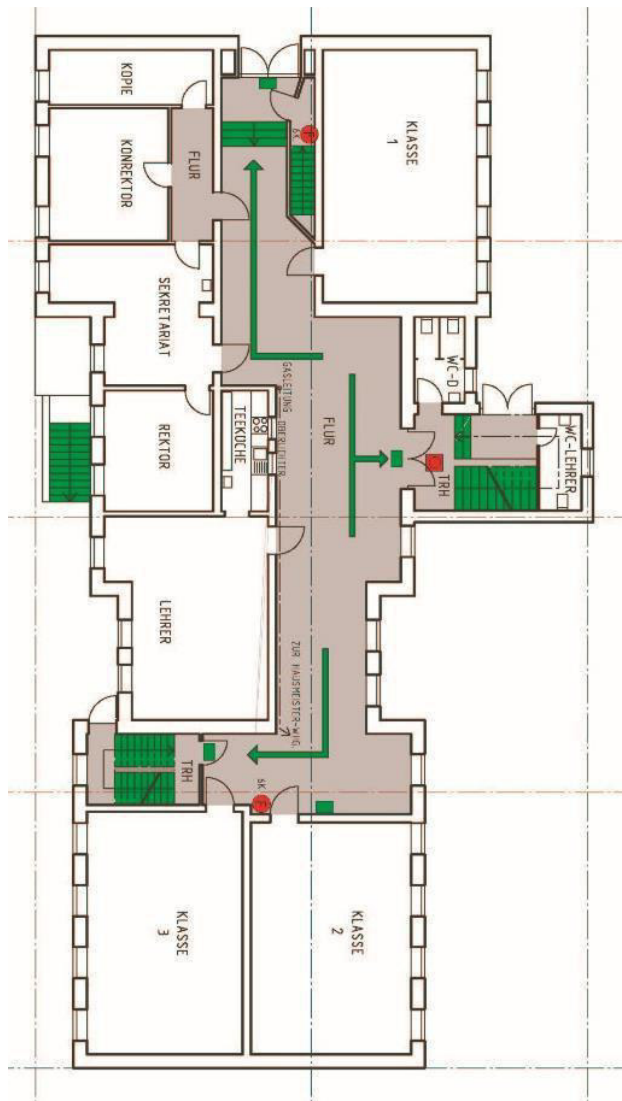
Grundriss EG Grundschule Klostergang (Quelle: Stadt Zeven, Feuerwehreinsatzplan)
